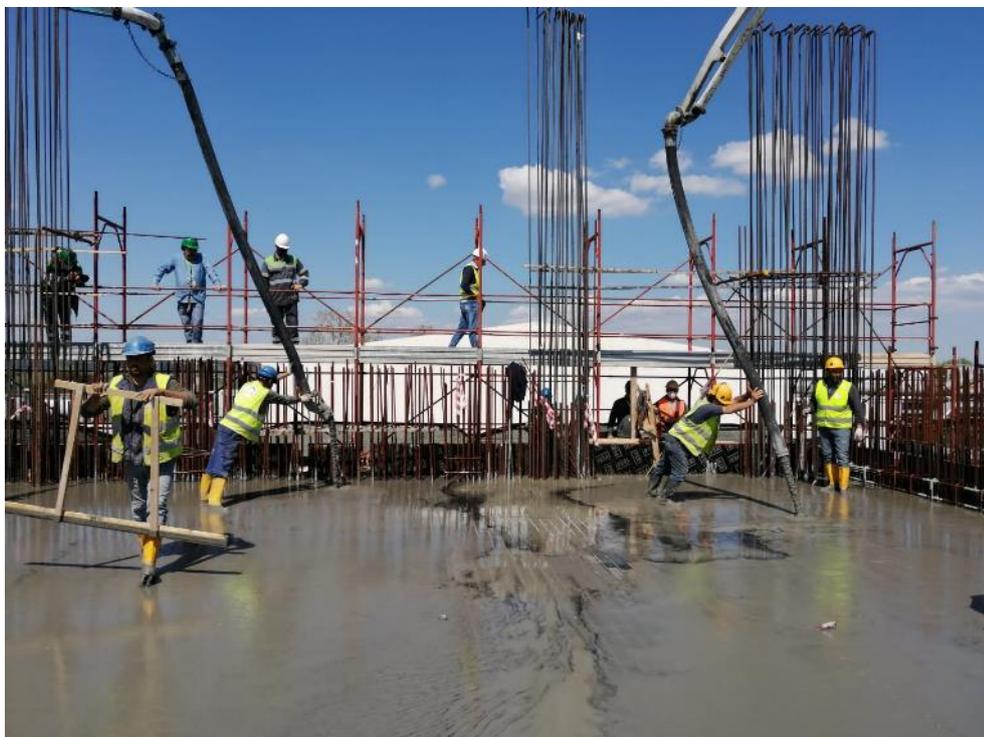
Foto di cantiere particolare getto solaio a quota + 5,95
